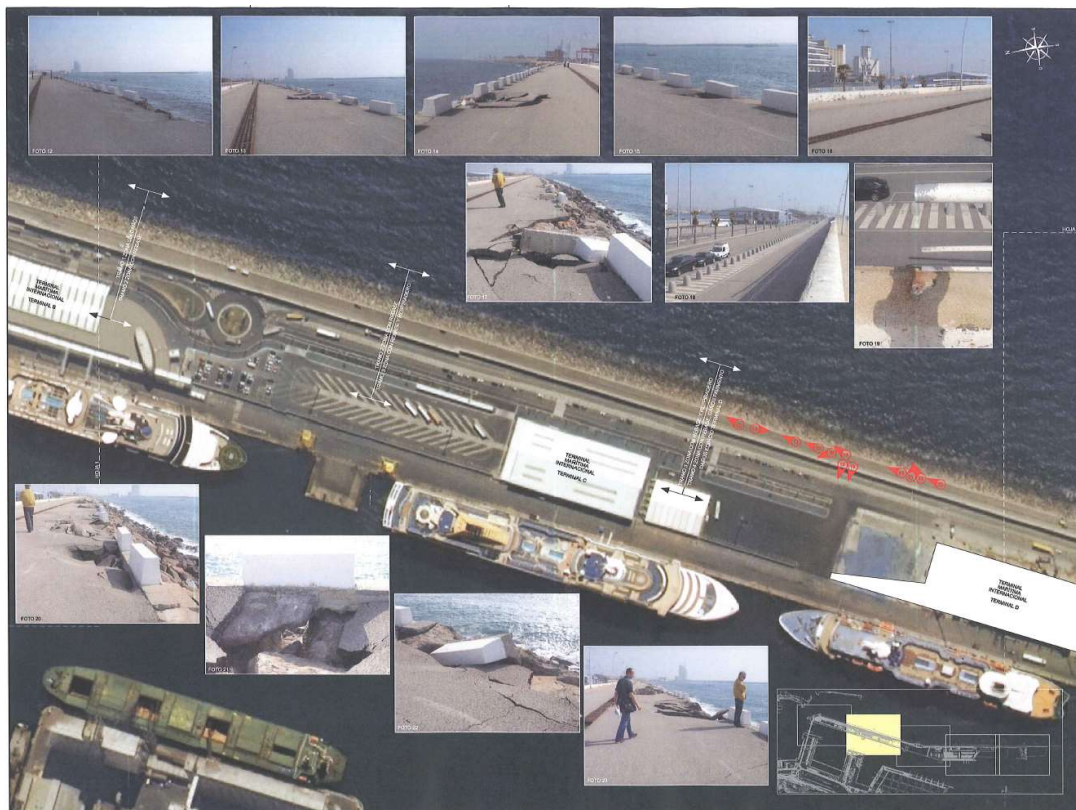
Tramo 2.2 empieza a faltar material puntualmente y roturas de pavimento
